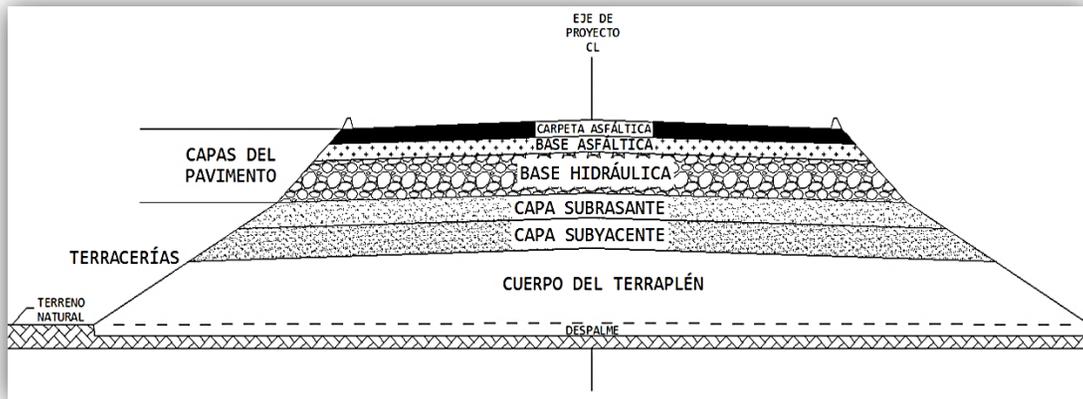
Sección transversal típica de una carretera cuyo pavimento es flexible. Se puede observar que el cuerpo de terracerías está conformado por el terraplén, una capa de transición o subyacente y la capa subrasante; por otra parte, el pavimento queda conformado por una base hidráulica, una base asfáltica y una carpeta de rodamiento de asfalto (ref. 14).
